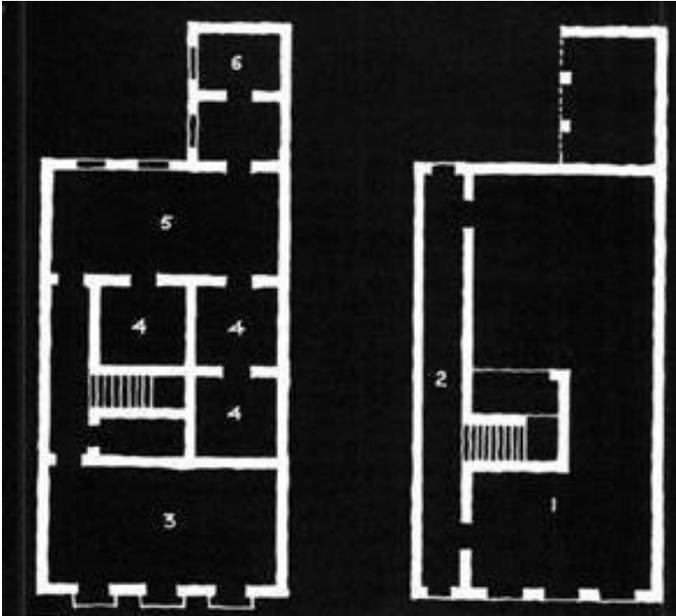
Planta dos casarios de planta simplificada, do período colonial.
